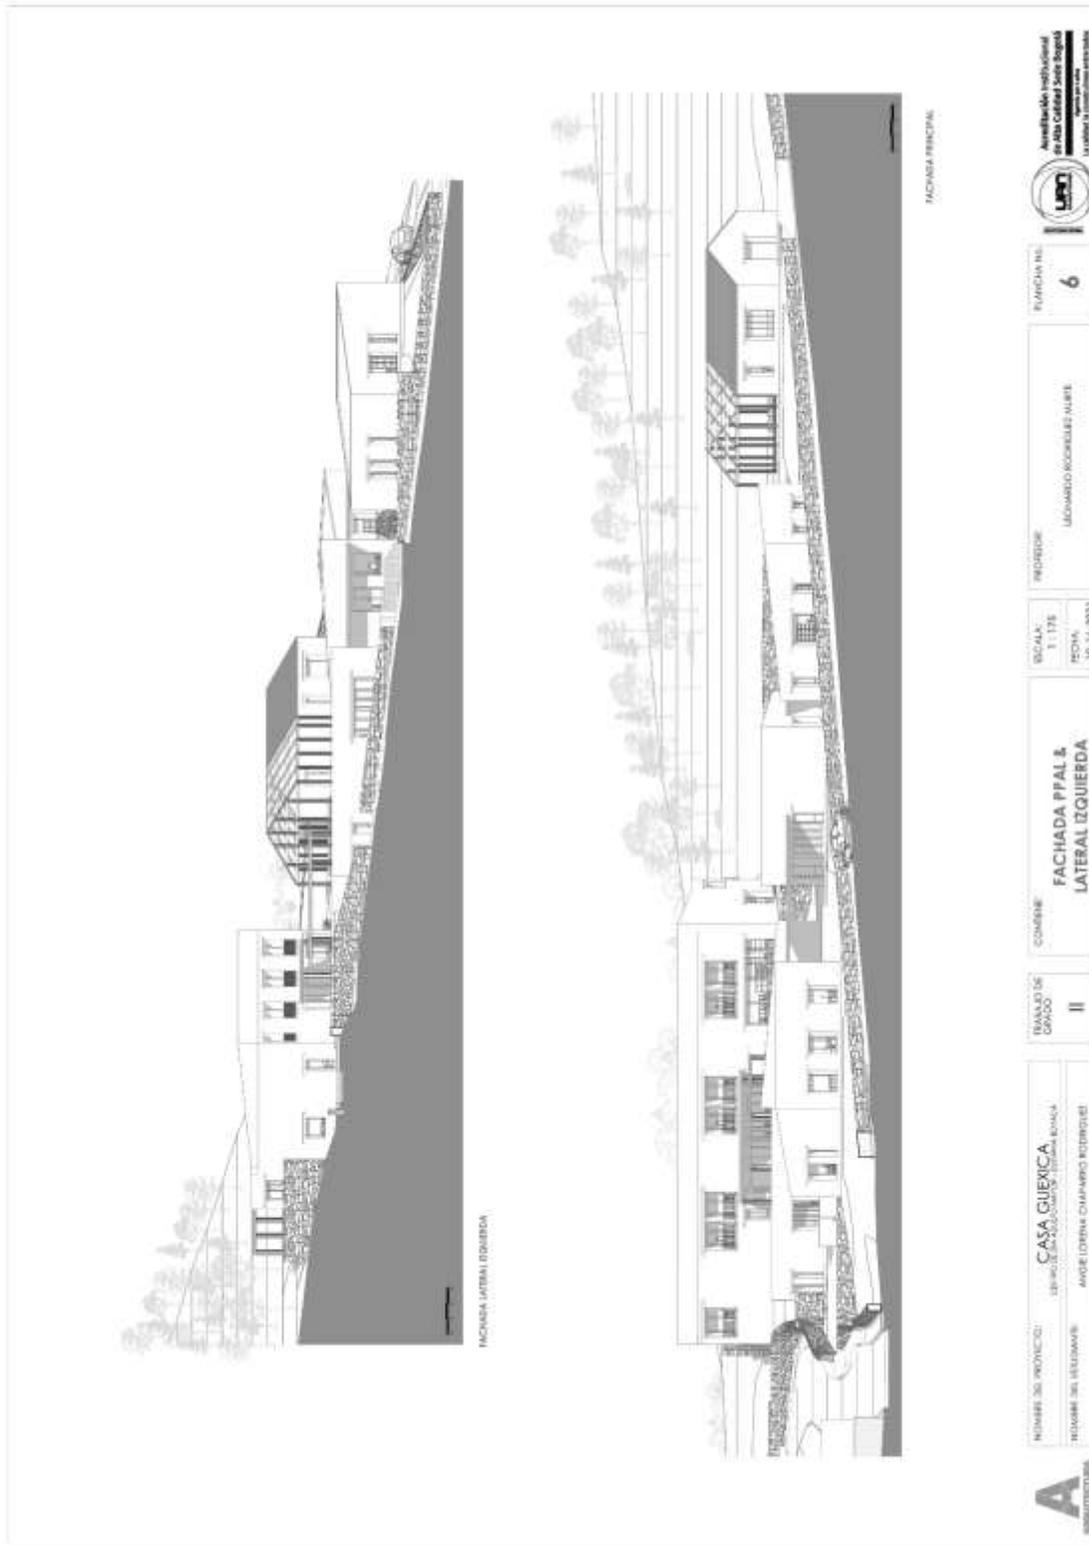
Fachada Principal y fachada Lateral Izquierda
